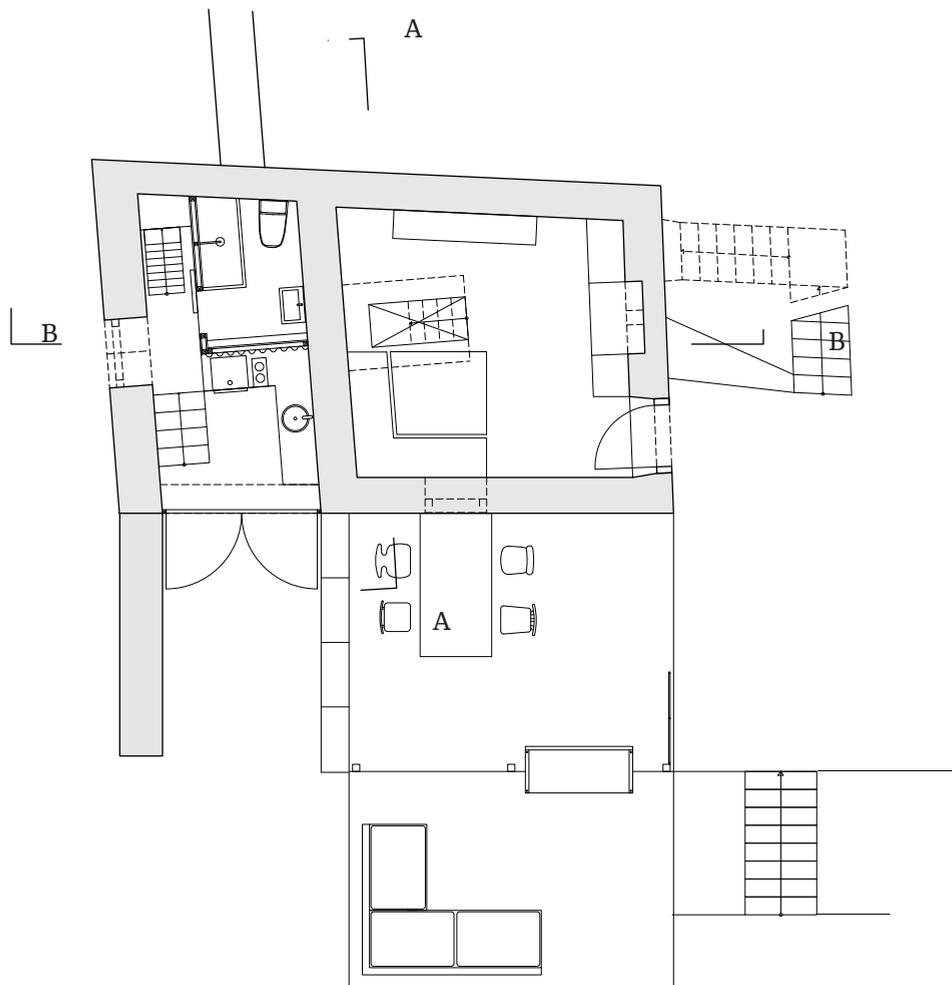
Entwurf Grundriss Untergeschoss
